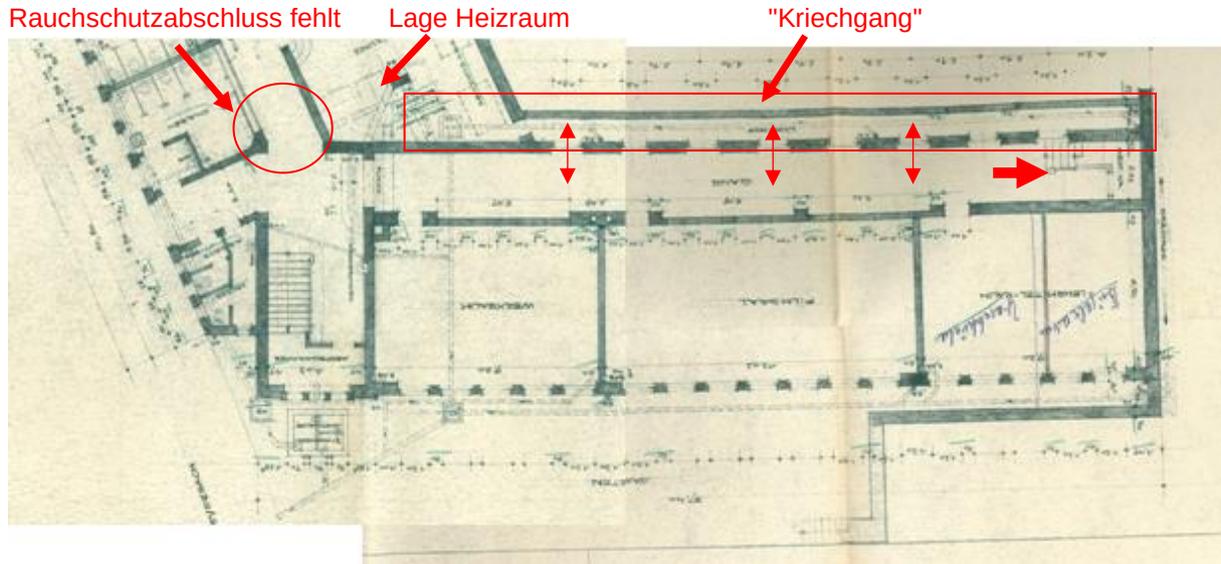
Grundriss Untergeschoss mit Heizraum und Lages des fehlenden Rauchabschlusses
